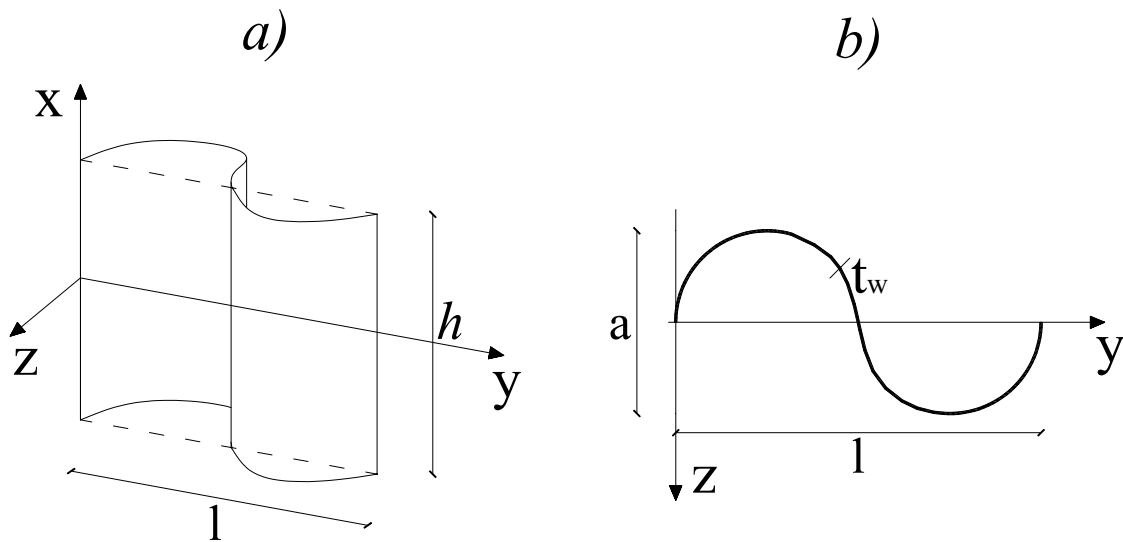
Profilo sinusoidale dell'anima: a) vista 3D b) sezione
